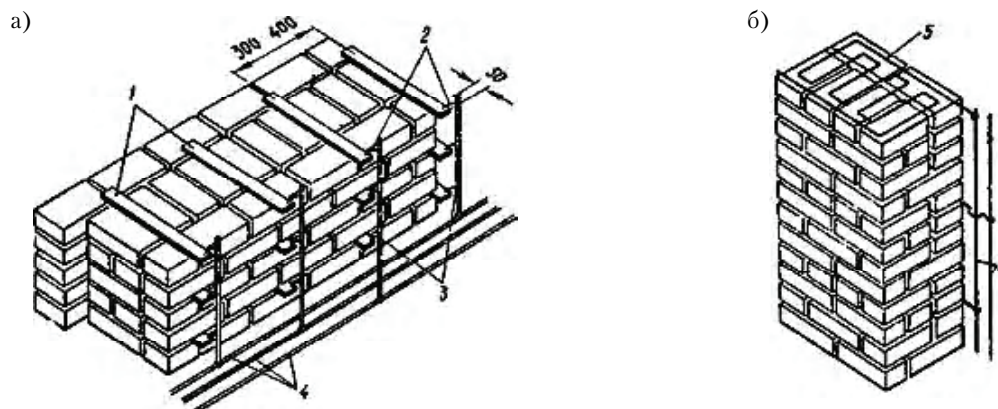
Схема электропрогрева кладки: а) кирпичной стены; б) армированной кладки столбов; 1 – пластинчатые электроды; 2, 3 – коммутационные провода; 4 – электрическая сеть ($U = 220...380 \text{ В}$); 5 – стальная сетка.
